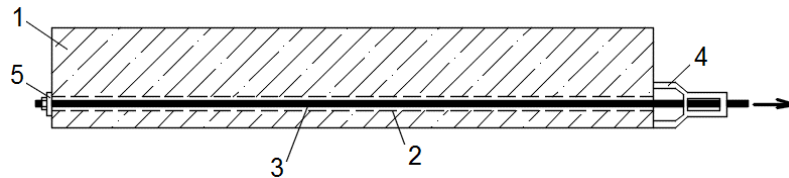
Попередньо напружений залізобетонний елемент з натягуванням арматури «на бетон»:
